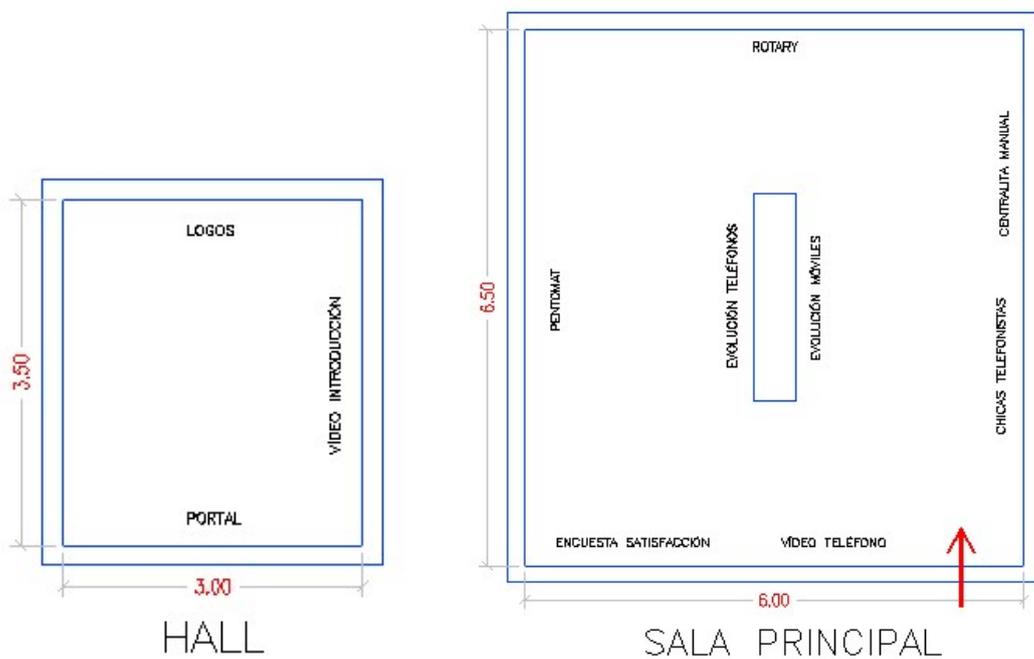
Vista de planta del Museo Virtual realizada con Autocad.
